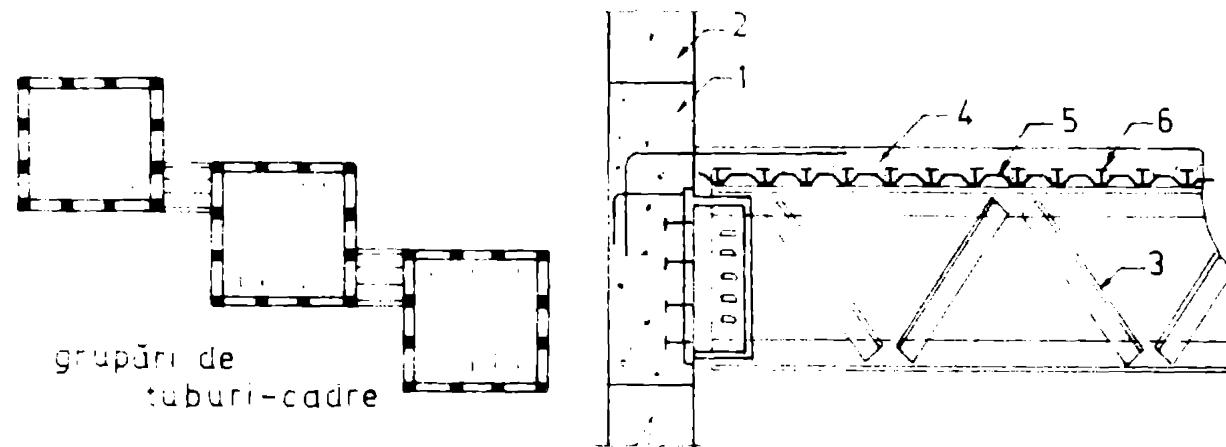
1-Grindă cadru beton armat exterior. 2-Stîlp beton armat. 3-Grinda cu zăbrele planșeu compus. 4-Placă beton armat. 5-Profil tablă cutată. 6-Elemente de legatură tip dorn cu cap
